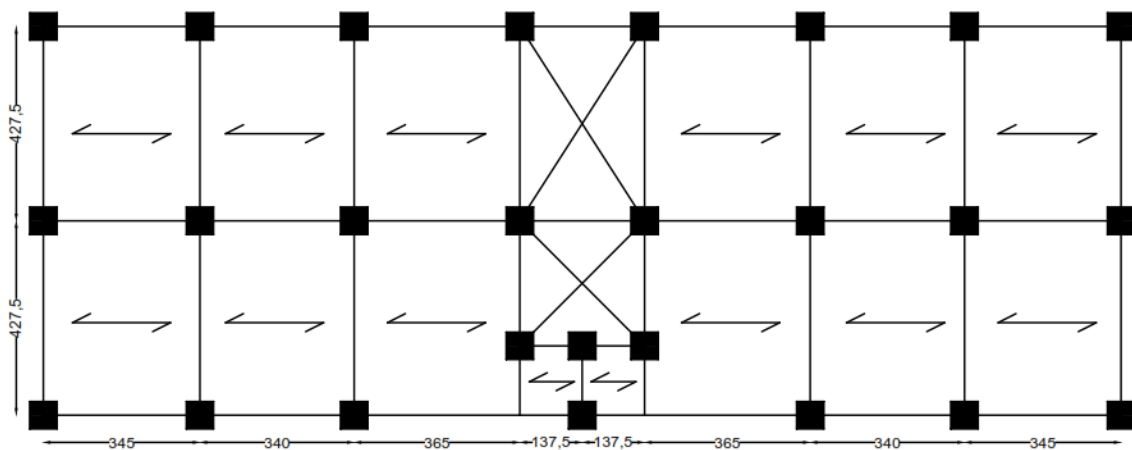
Schéma de la disposition des poutrelles pour les étages courants.
